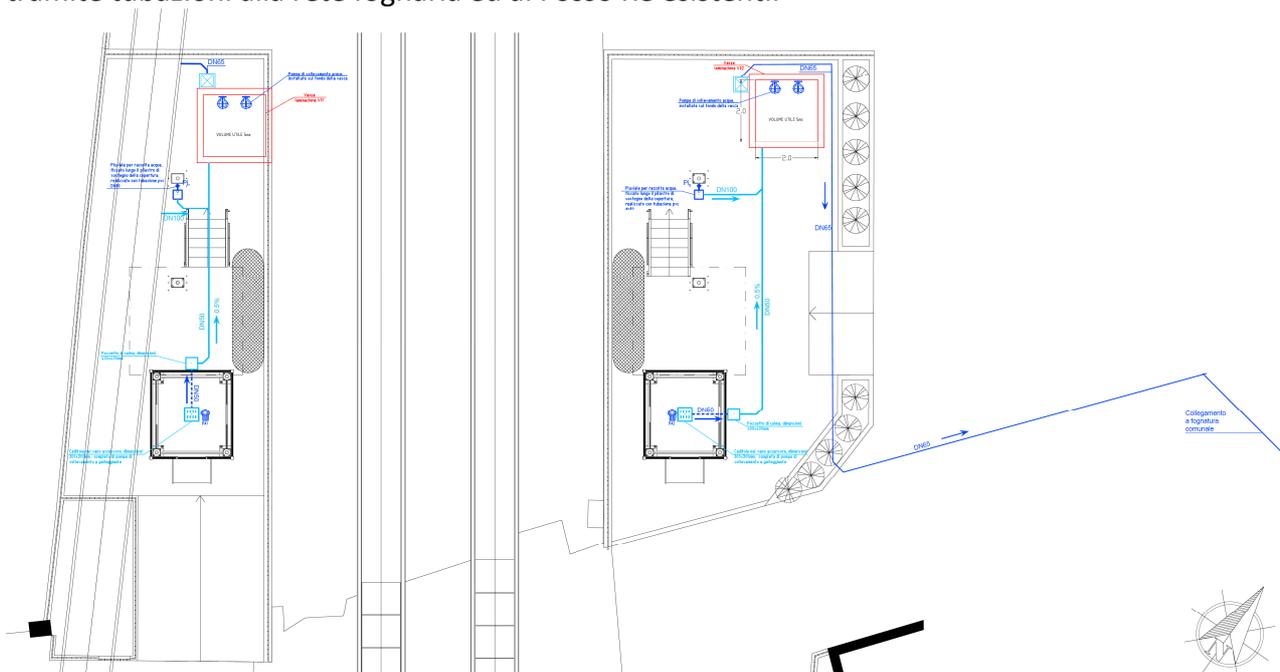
Estratto planimetria generale impianti meccanici al piano terra
